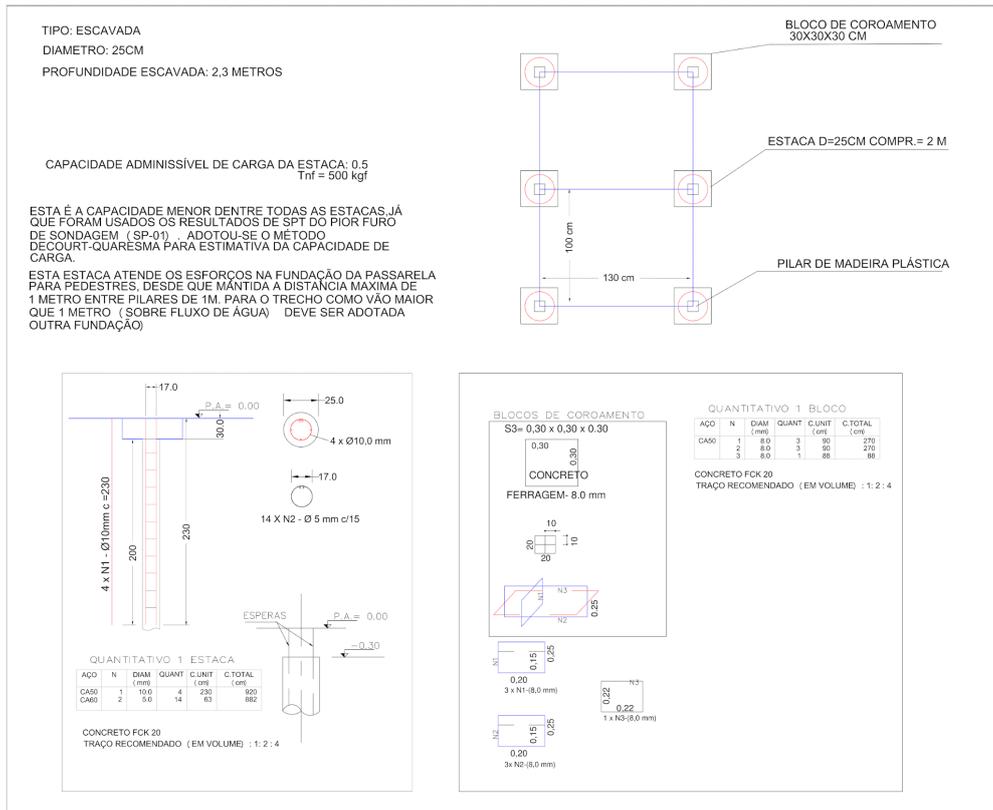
Corte esquemático de fundação para trecho da trilha em madeira plástica.
